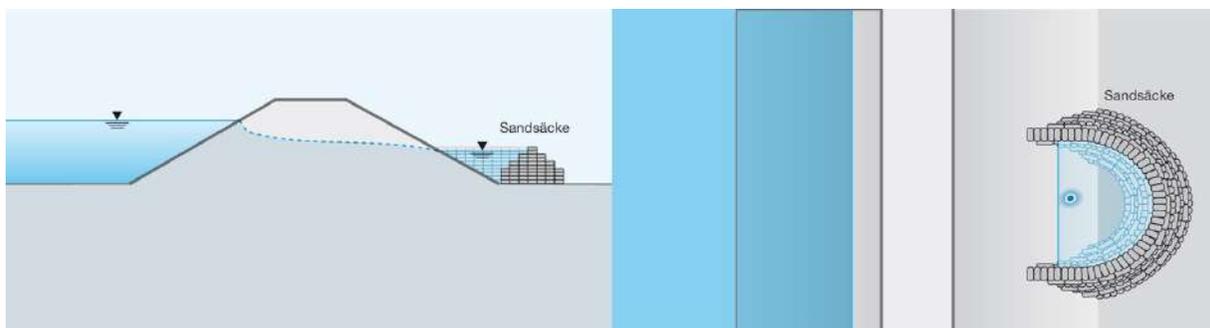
Aufbau und Grundriss eines Fangedamms / Quellkade
